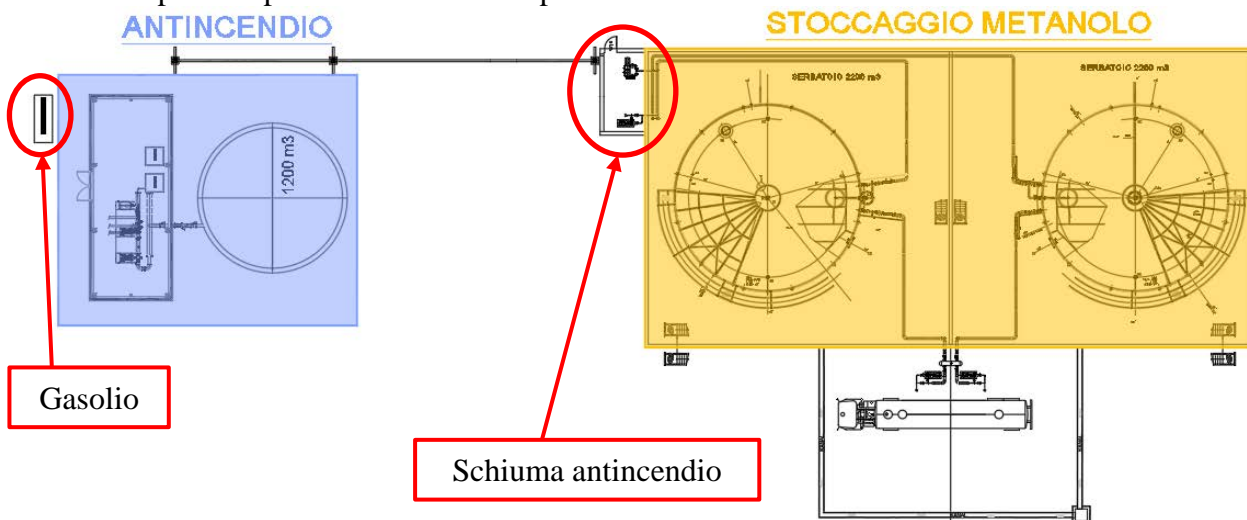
Stralcio planimetria con ubicazione stoccaggio schiuma antincendio e gasolio
